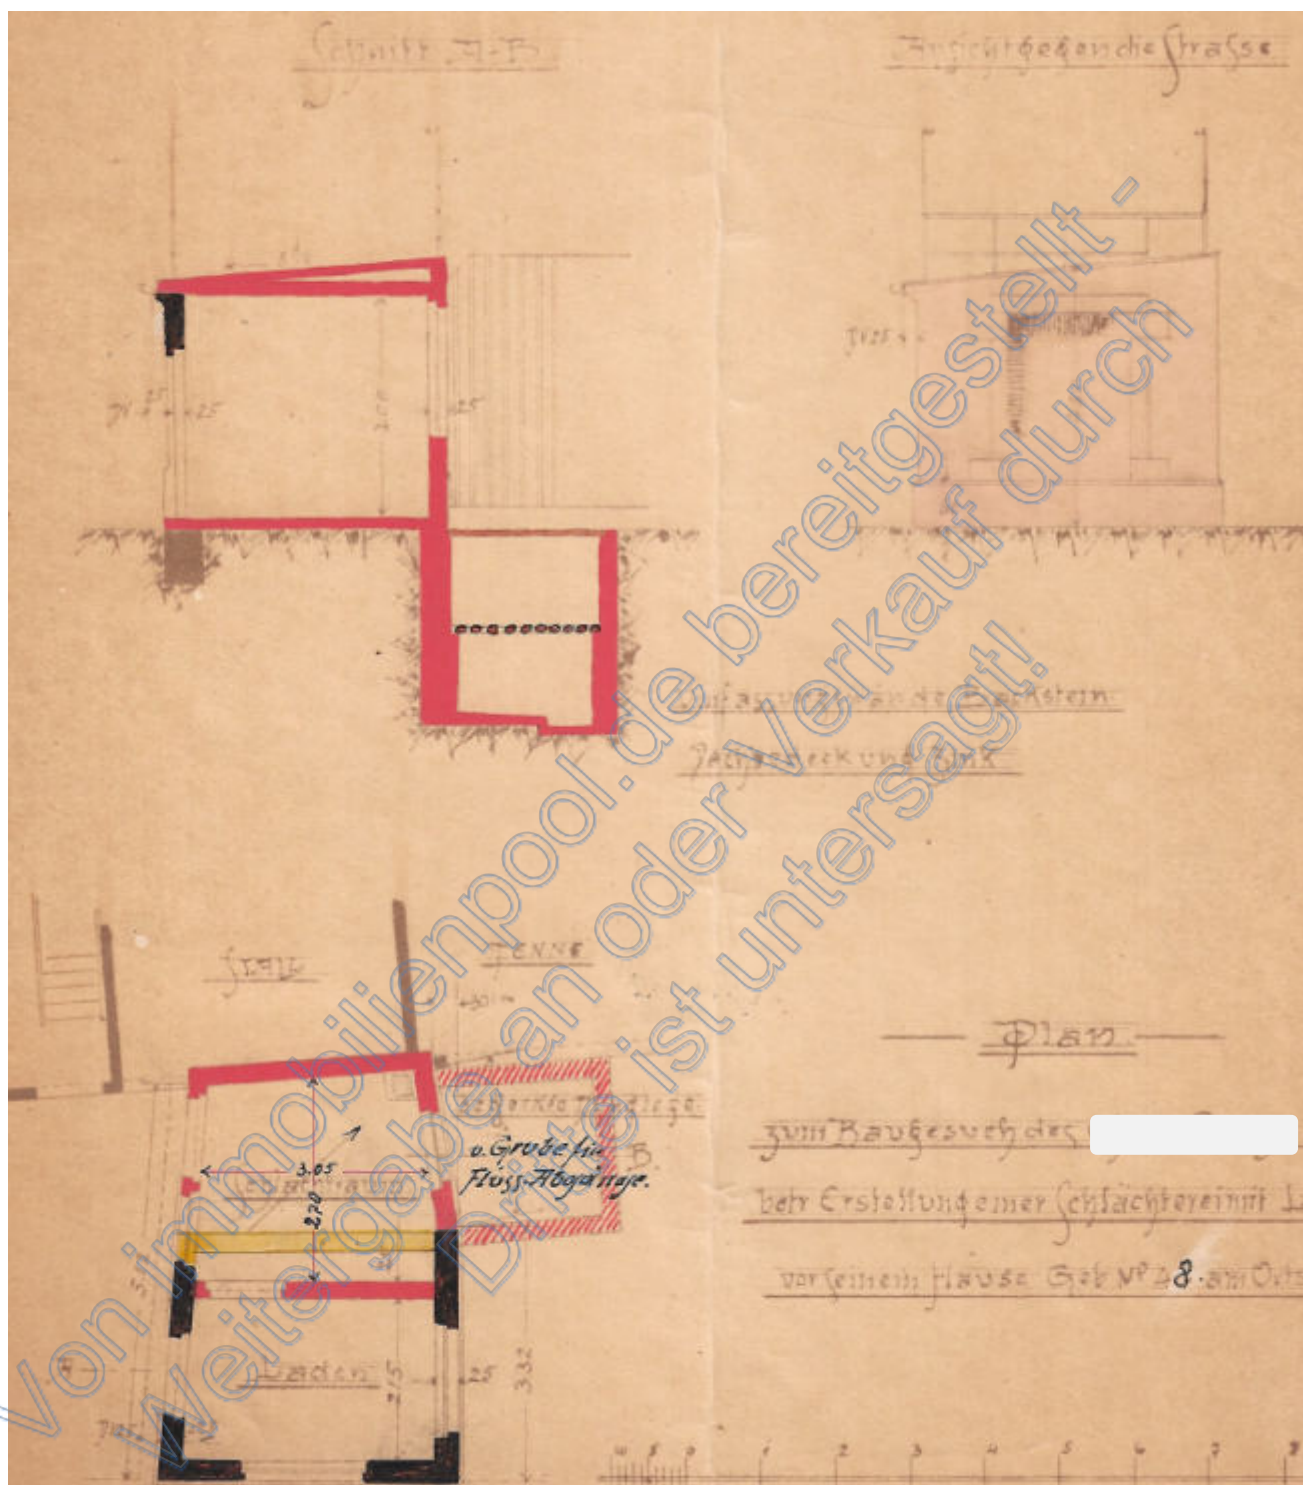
Grundriss, Ansicht und Schnitt zum Baugesuch von 1906 (Erstellung einer Schlächterei mit Laden); Quelle: Bauakte; Anonymisierungen d.d.SV
